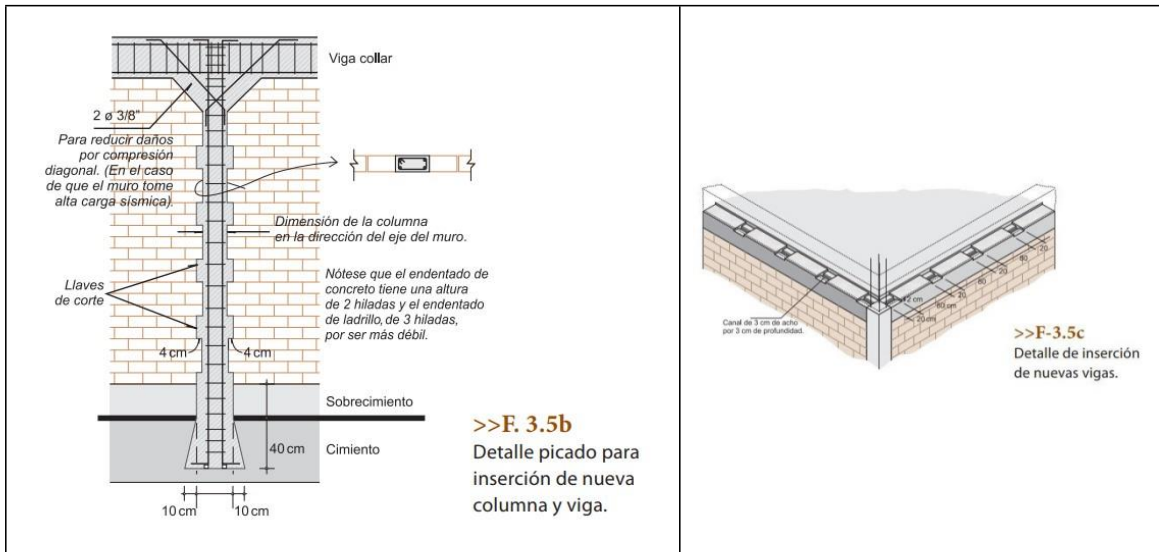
Esquema detalle de reforzamiento con columna de confinamiento en muro. Tomado de Vivienda (2019)
